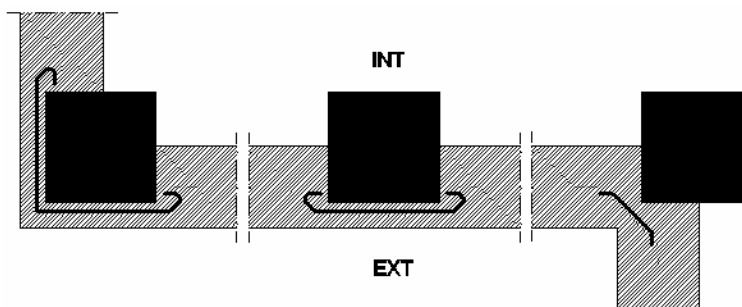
Ejemplo de encuentro de la fachada con los pilares
